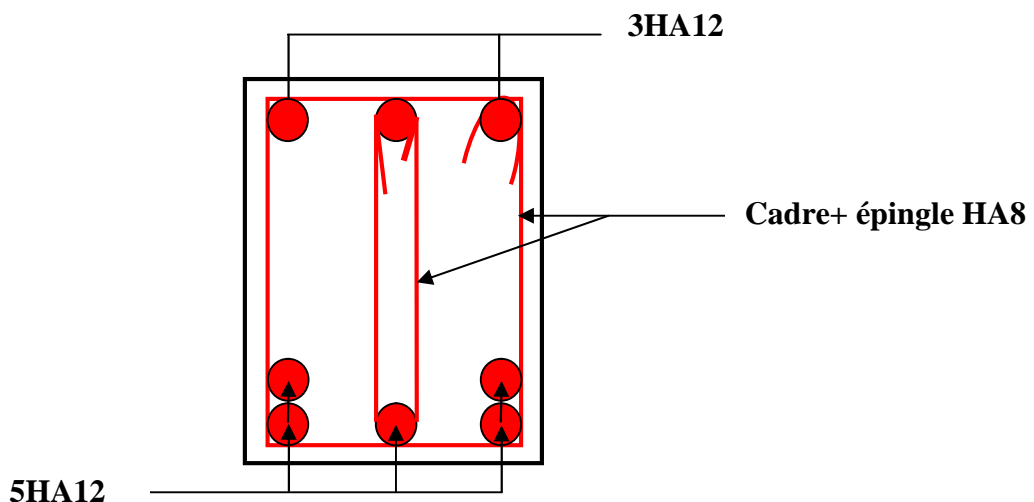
ferrailage de la poutre de chainage a coté de l'ascenseur
